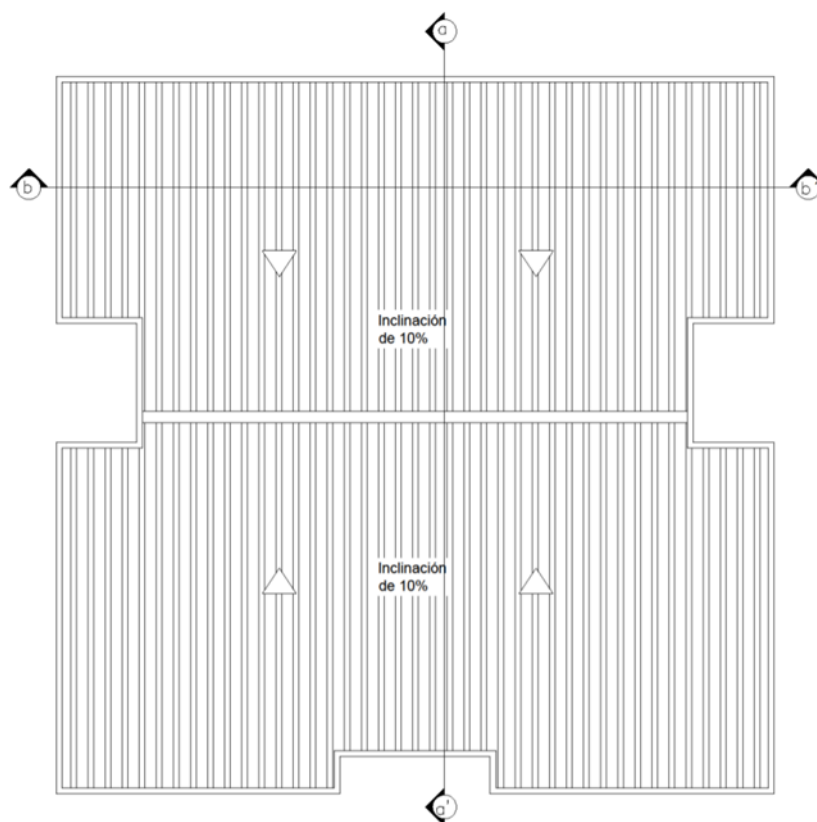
Diseño de la cubierta del edificio, constructora Proyectos y Soluciones de Ingeniería P.S.I. Ltda. Fuente: Creación propia.
